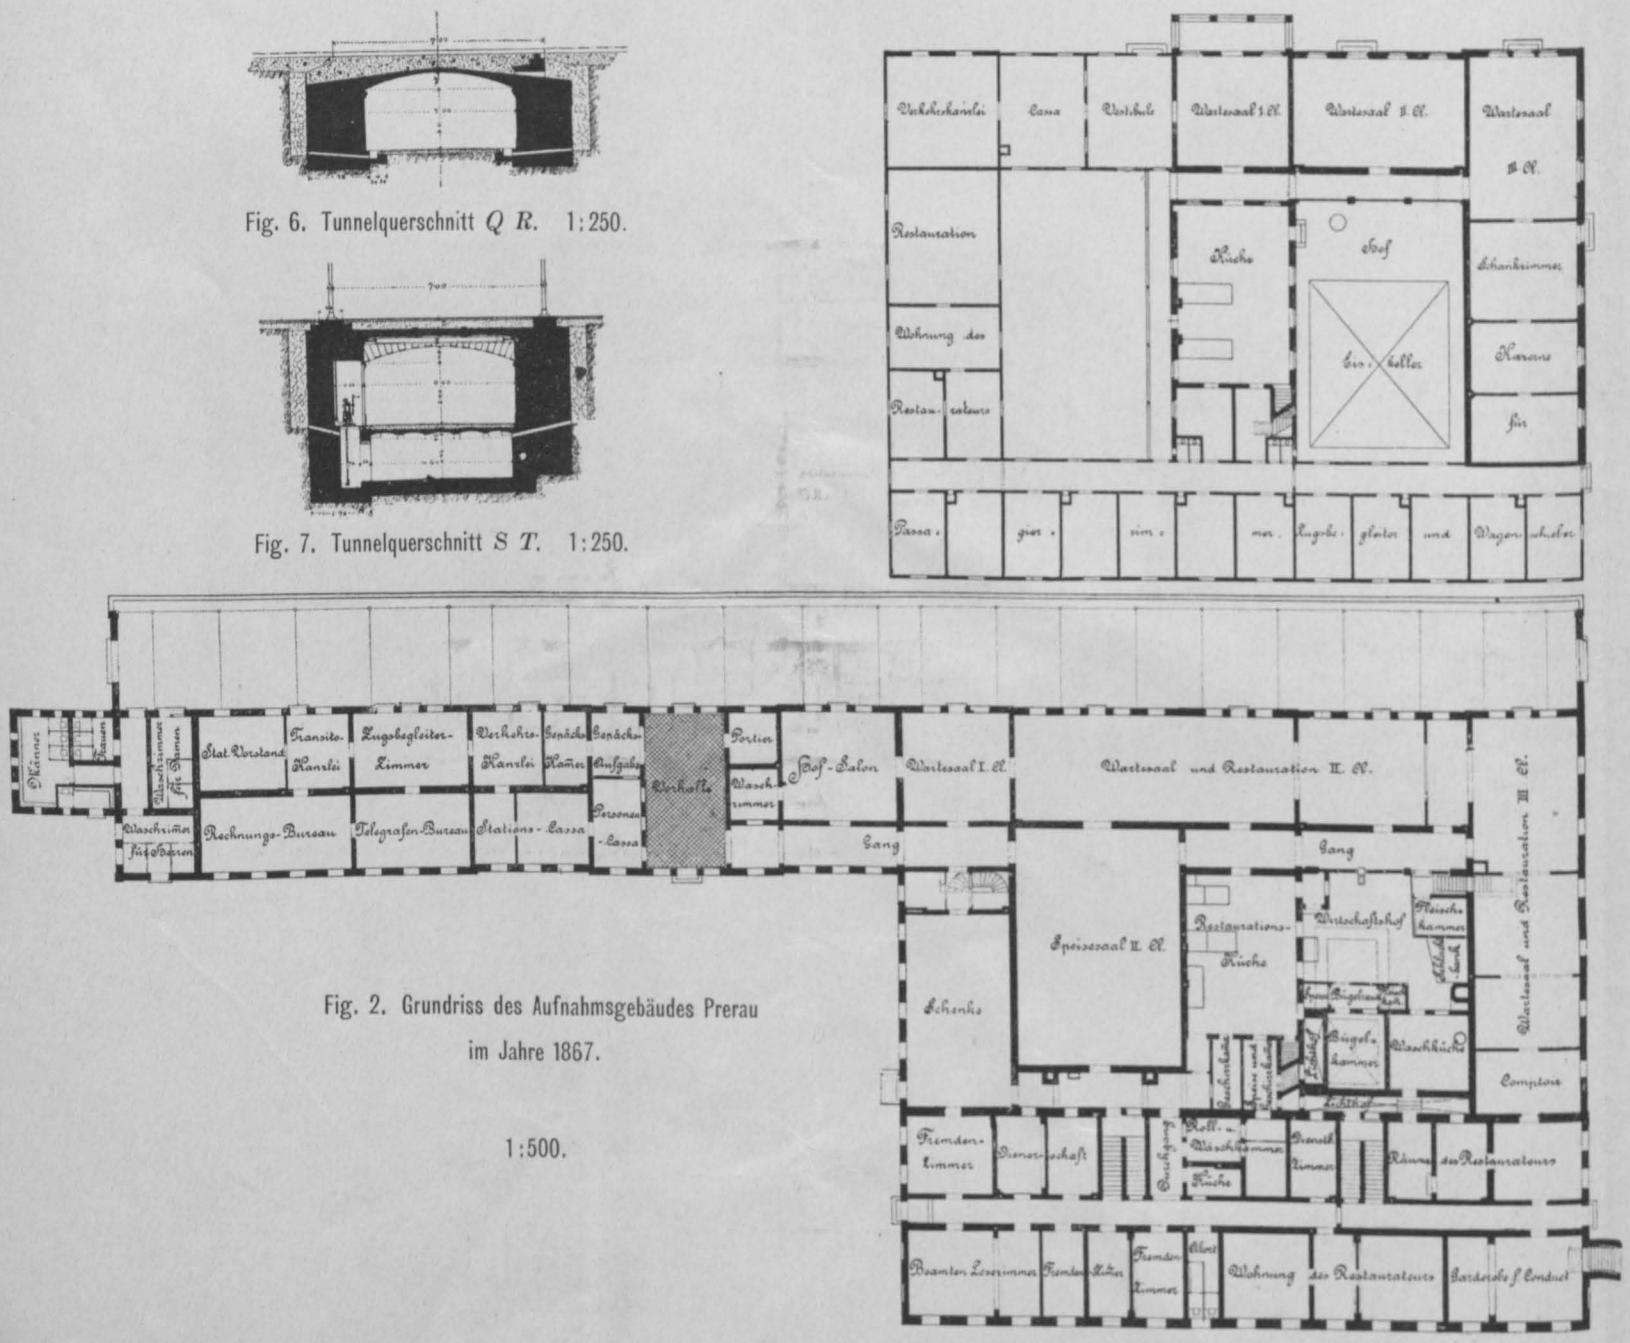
Grundriss des Aufnahmegebäudes Prerau im Jahre 1867.
